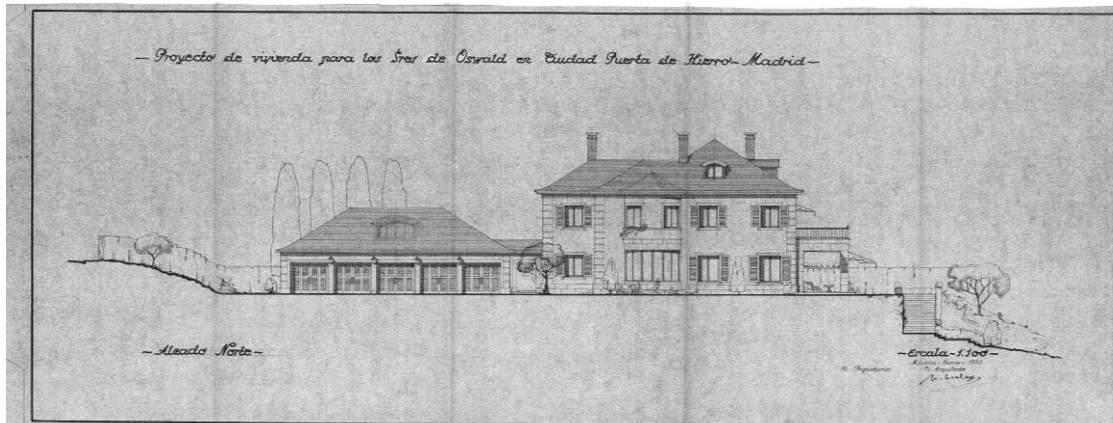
Alzado Norte, Casa Oswald (1952) Matilde Ucelay. Fuente: Javier Vilchez Luzón por cortesía de Ministerio de la vivienda, Archivo Personal de Matilde Ucelay
